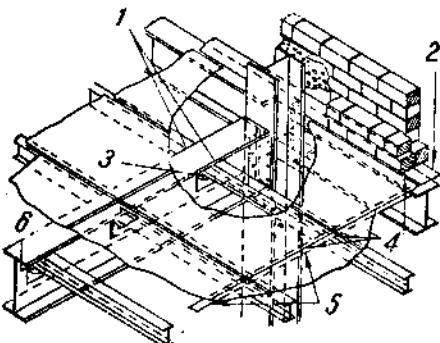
Детали конструкции междуэтажного перекрытия на лубяном типе.
